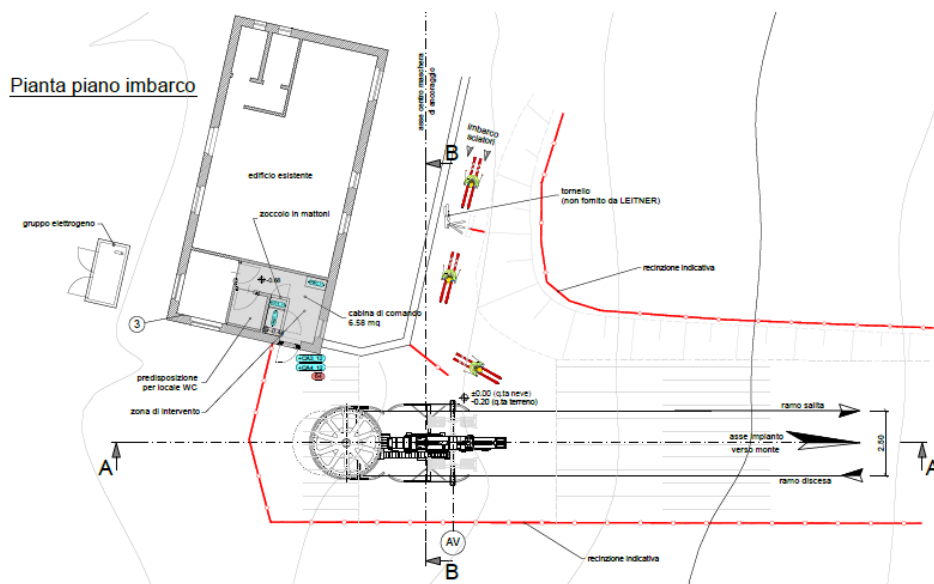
Pianta della stazione di valle in progetto e della zona di imbarco.
